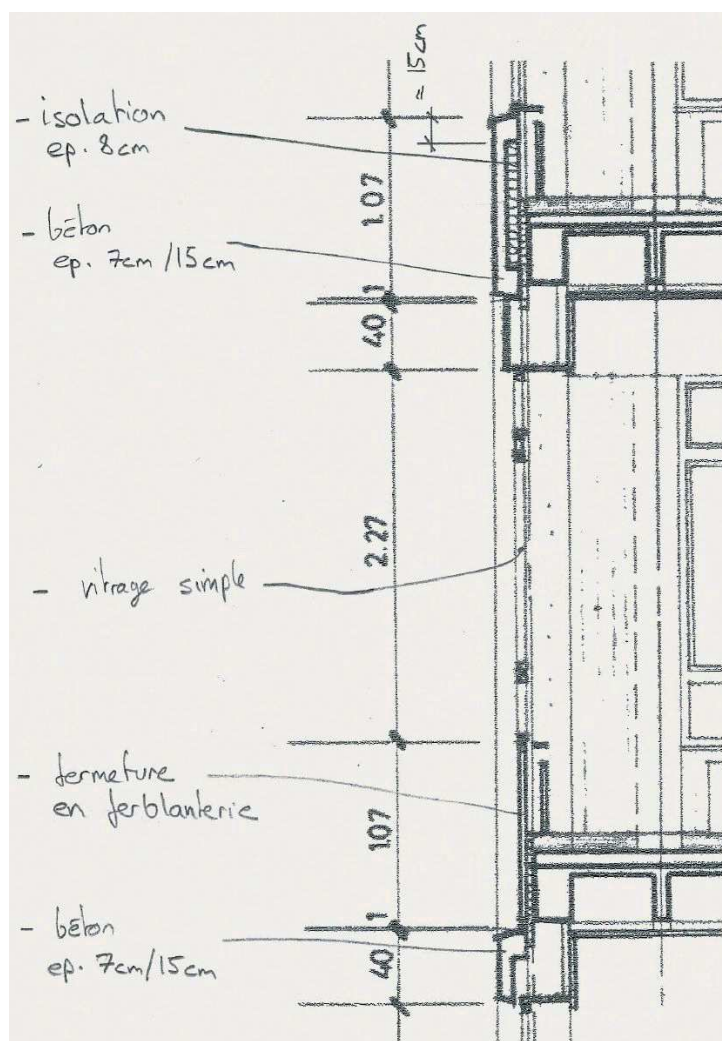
Détail de façade, extrait du plan num. 133
